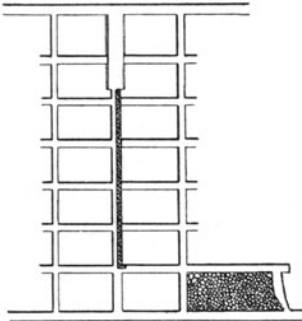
Bremsbergerherstellung und Breitaufhauen einer Grundstrecke bei steller Lagerung.
